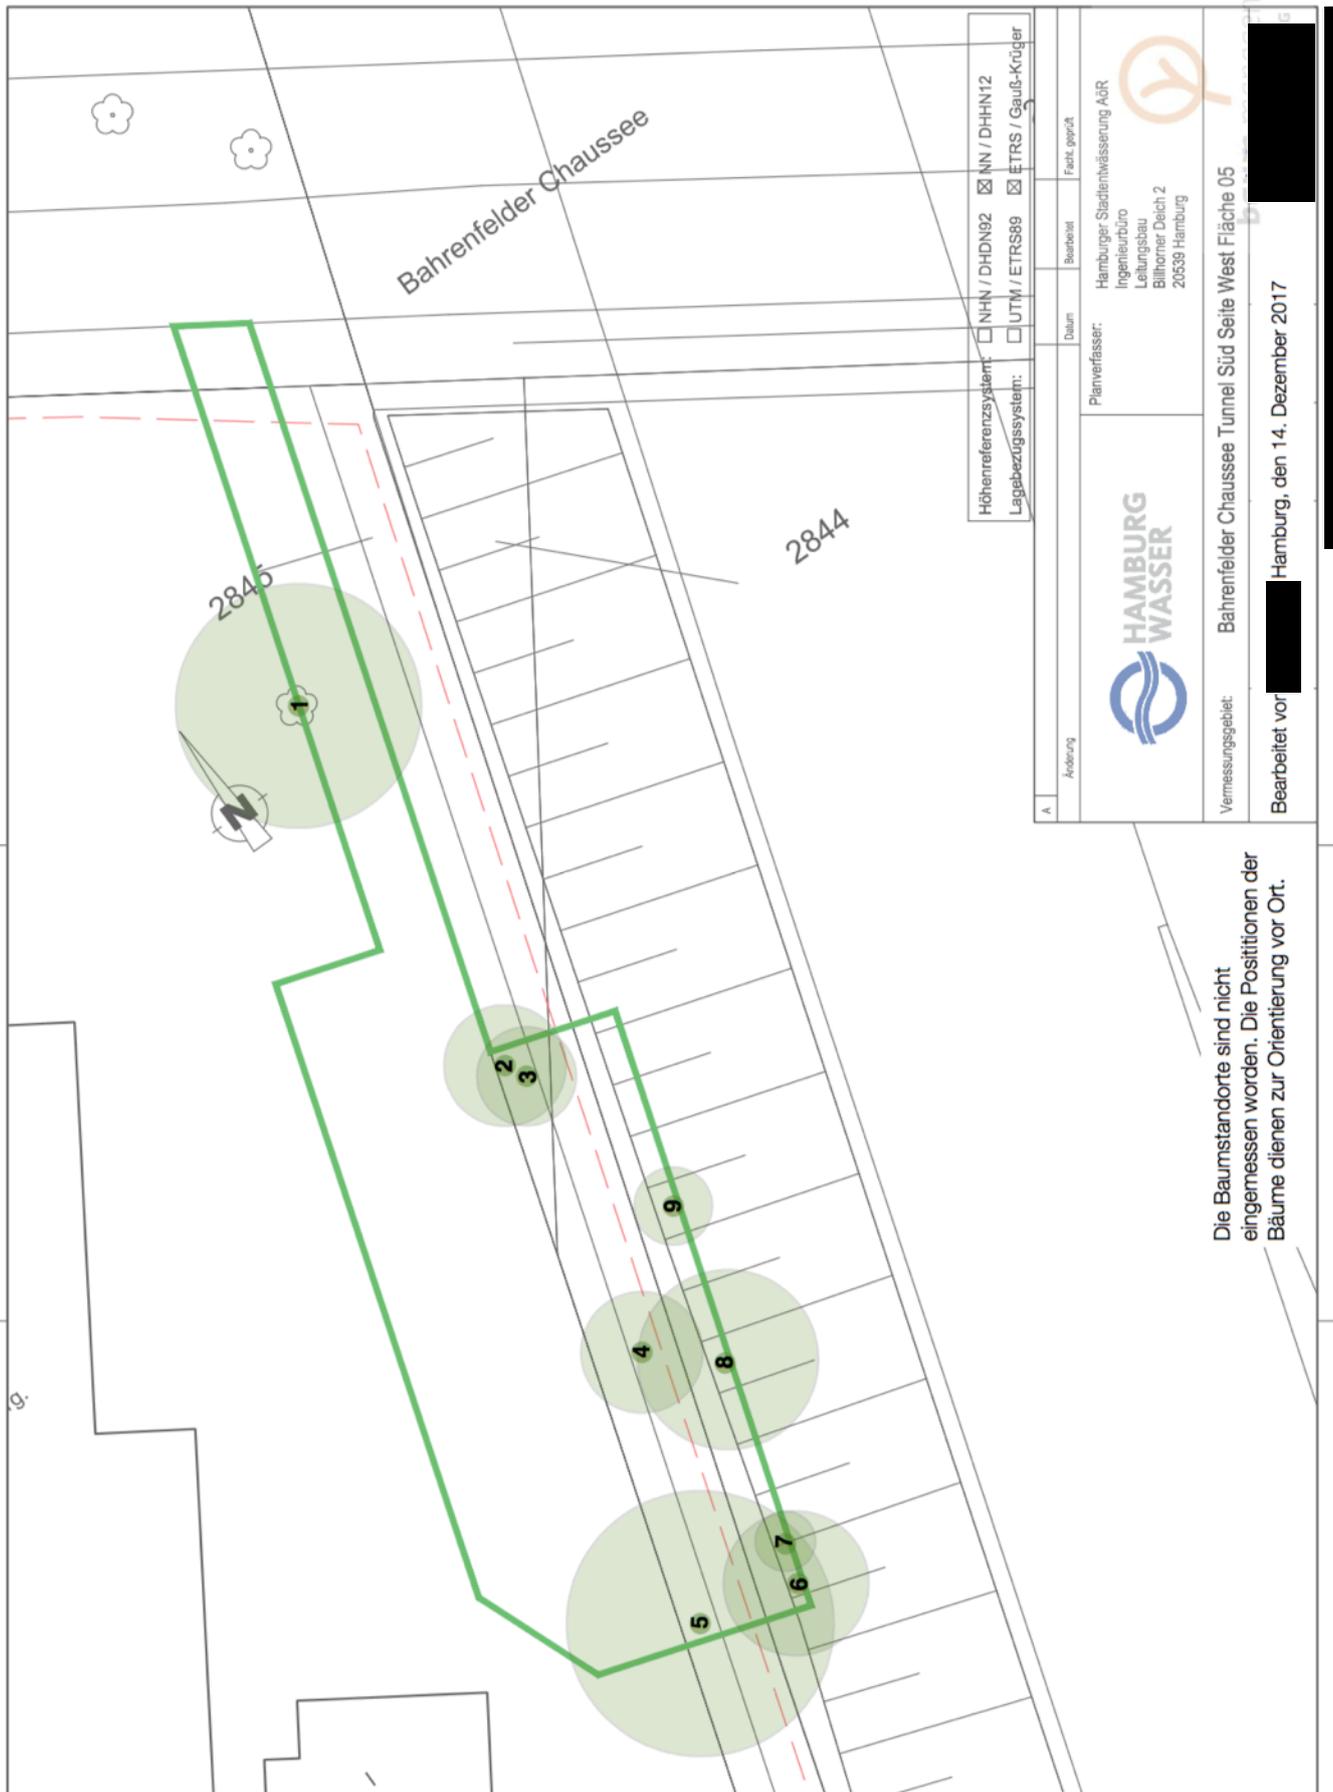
Fläche 05, Bahrenfelder Chaussee, Tunnel Süd, Seite West
